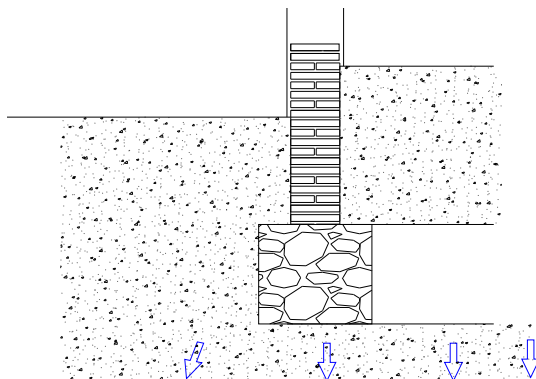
Detalle hipótesis cimentación. Fuente: Propia
